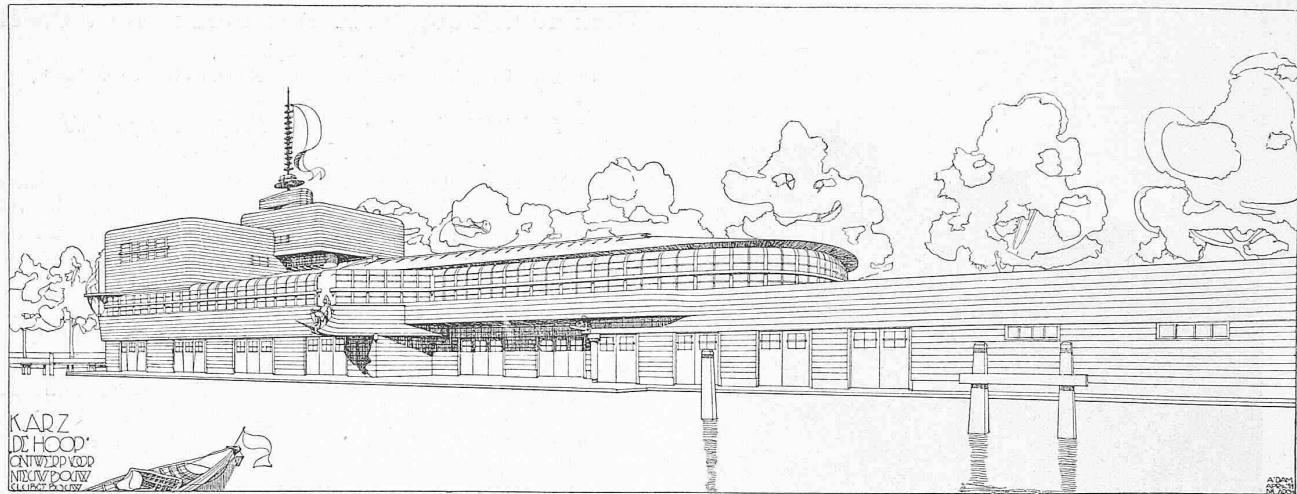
Klubhaus der Amsterdamer Ruder- und Segler-Vereinigung (Wasserseite). Architekt M. de Klerk (1922). Holzbau, unten Bootsschuppen, darüber Gesellschaftsräume (vergl. Grundriss Abb. 37). Der Entwurf entfaltet sich in einer vom Innern ausgehenden, das ganze Gebäude umspielenden und jede Einzelheit mitreissenden Bewegung, die sich der Ankunftsrichtung der Boote entgegenstellt.
